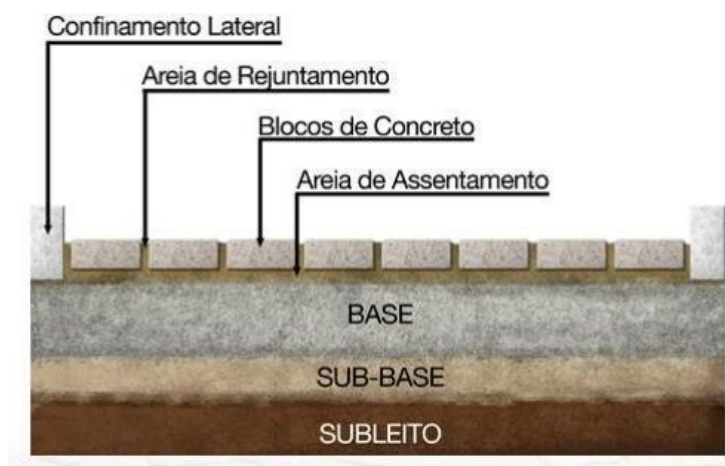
Detalhe esquemático para assentamento de piso intertravado.
